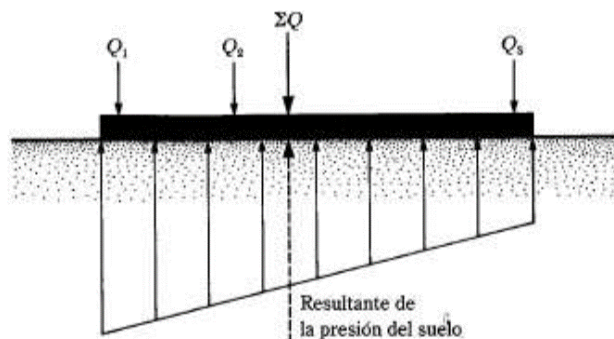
, Diseño de plateas de cimentación, fuente Braja M., 1999.
